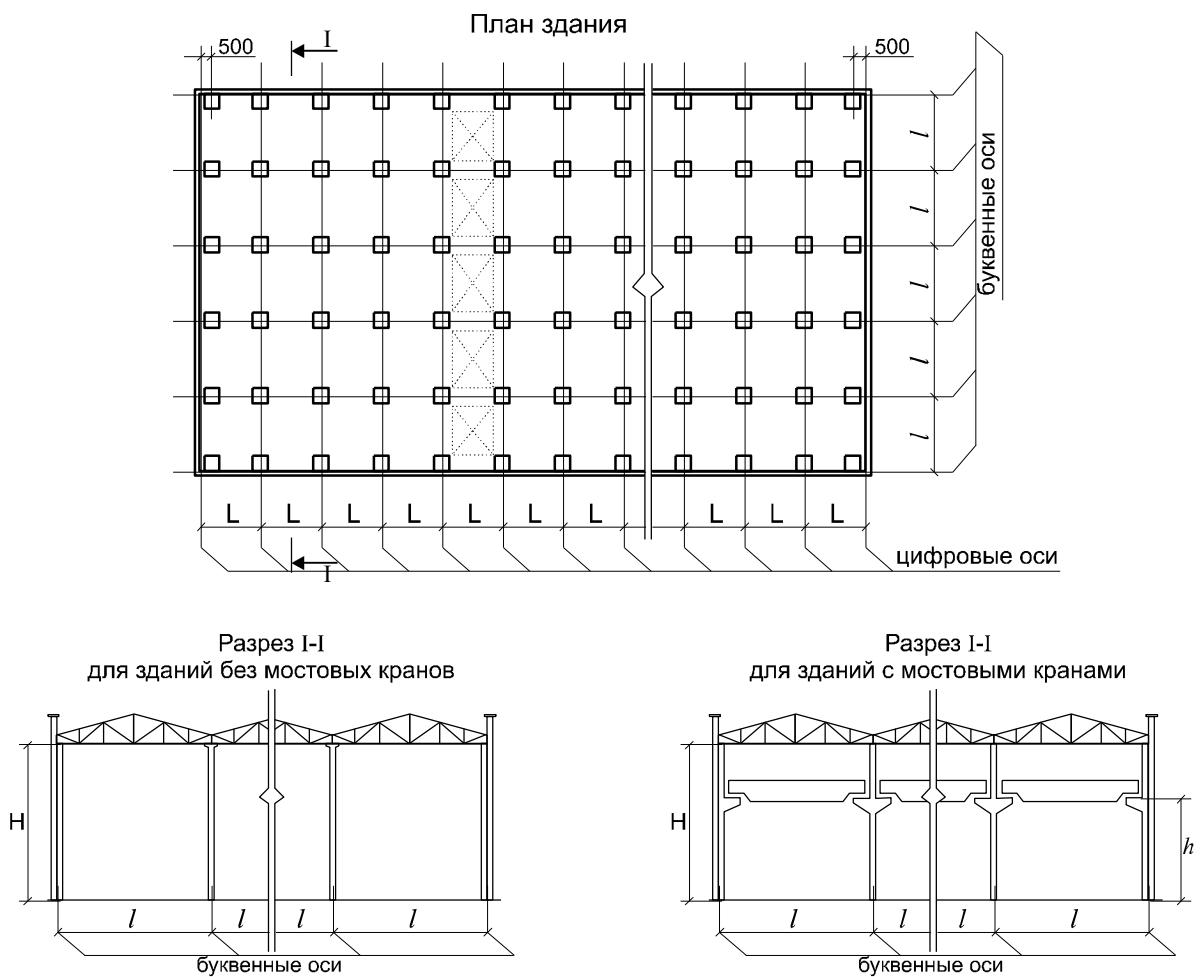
Конструктивно-планировочная схема одноэтажного промышленного здания.
